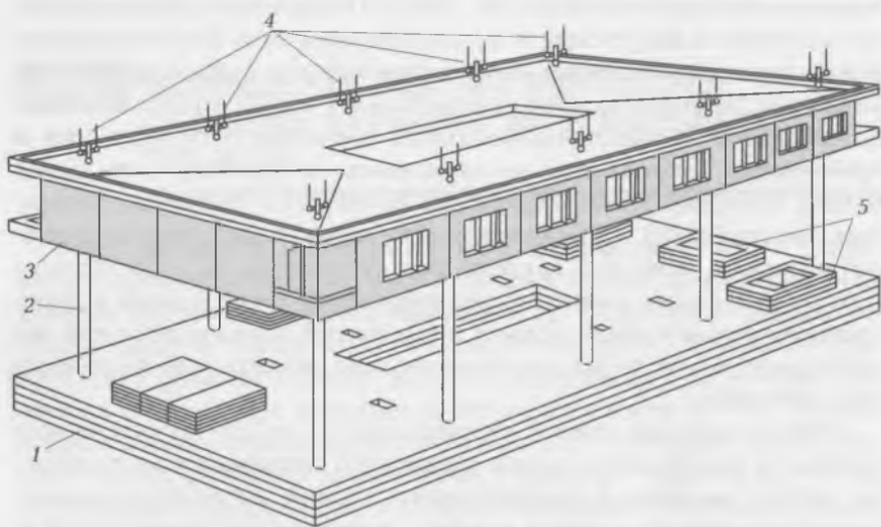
Схема возведения зданий методом подъема этажей:
